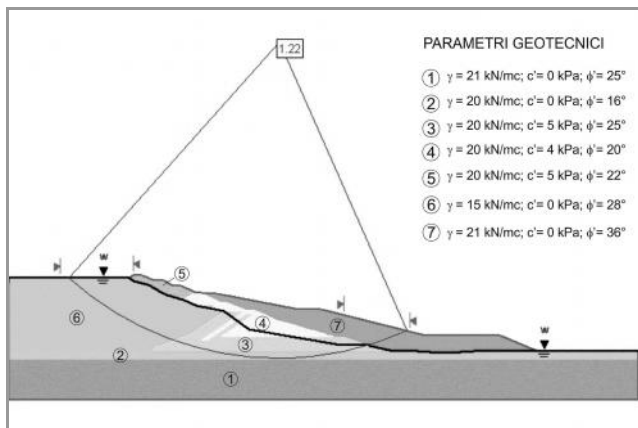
Verifiche di stabilità della sezione principale con ricalzo al piede
